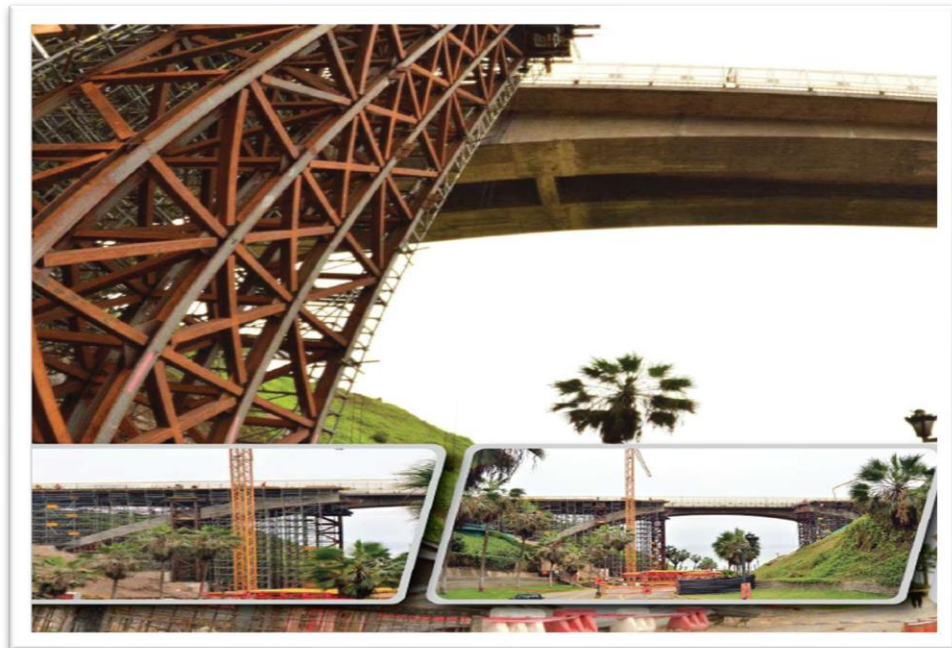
Proyecto Puente Arica Ubicado Km 40 Lima Perú. Construcción JCB Estructuras 2017
